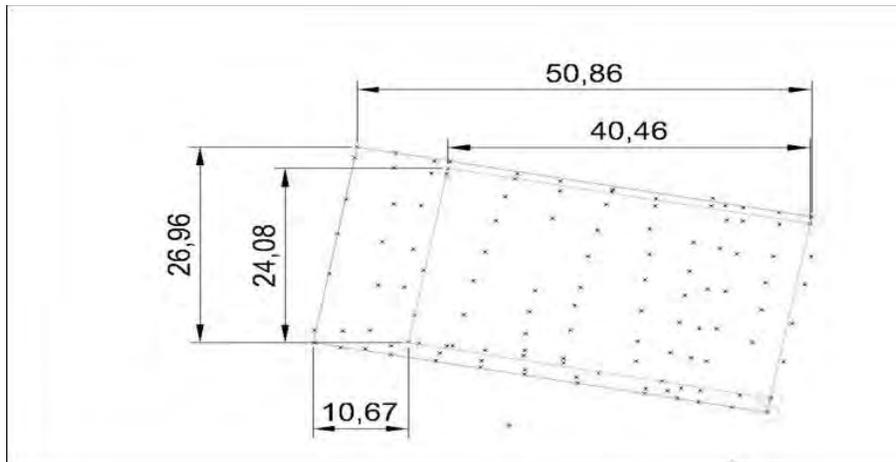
Levantamiento topográfico de la ex planta Cloro-Sosa y área de fosa.
